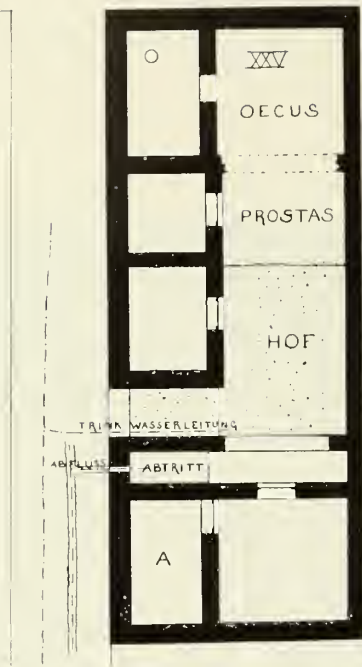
Grundriss des Hauses Nr. XXV.
